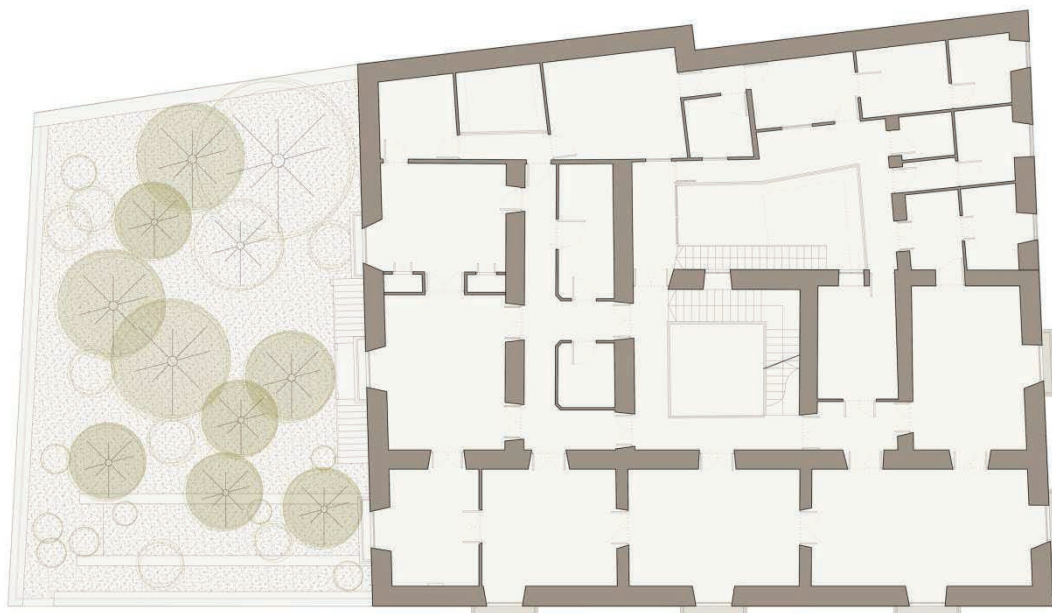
Planta primera de la Casa de los Arcas, por Rosario Baños Oliver
